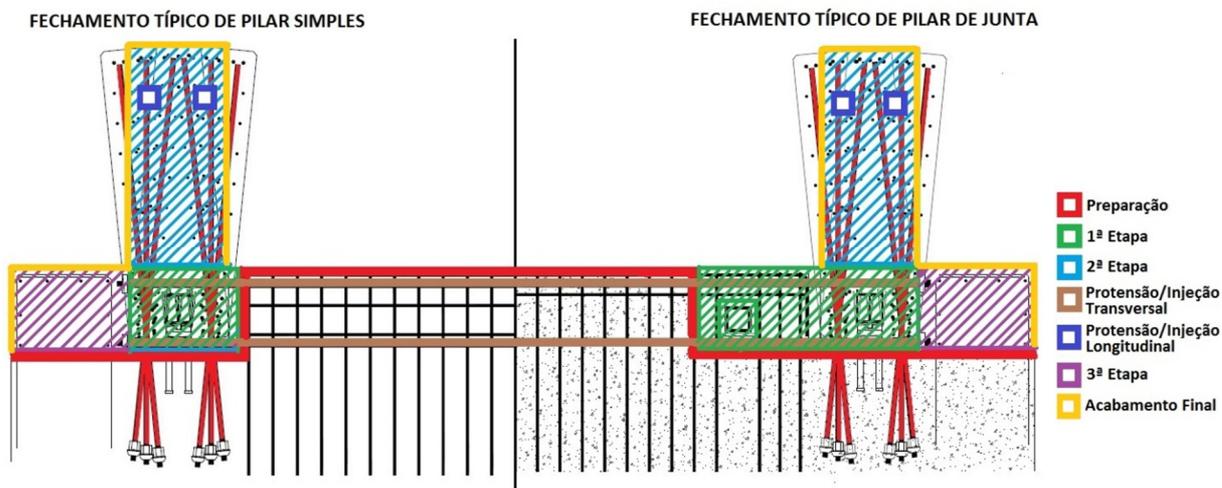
Vista das etapas de execução dos fechamentos de viga-guia
